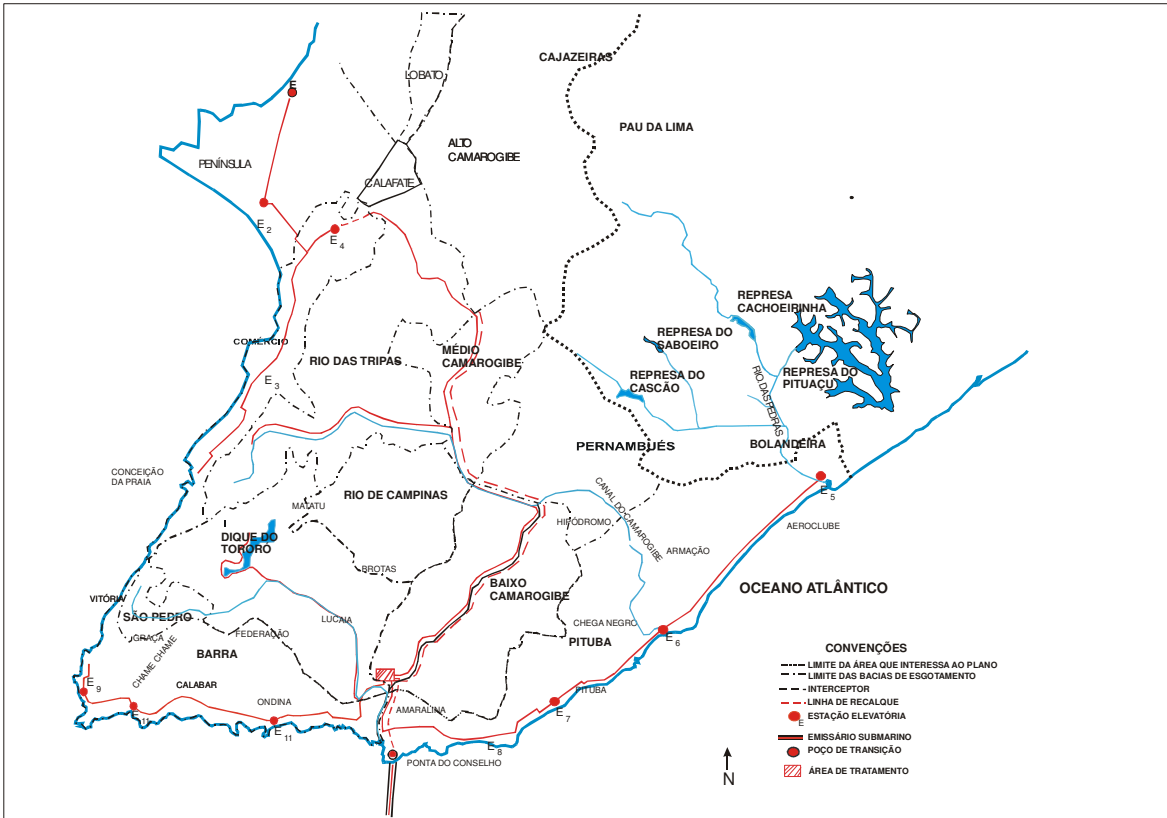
Esgotamento Sanitário de Salvador conforme Planejamento Geral elaborado por Walter Sanches e Escritório Enaldo Peixoto – 1968 (EMBASA, 2003).
